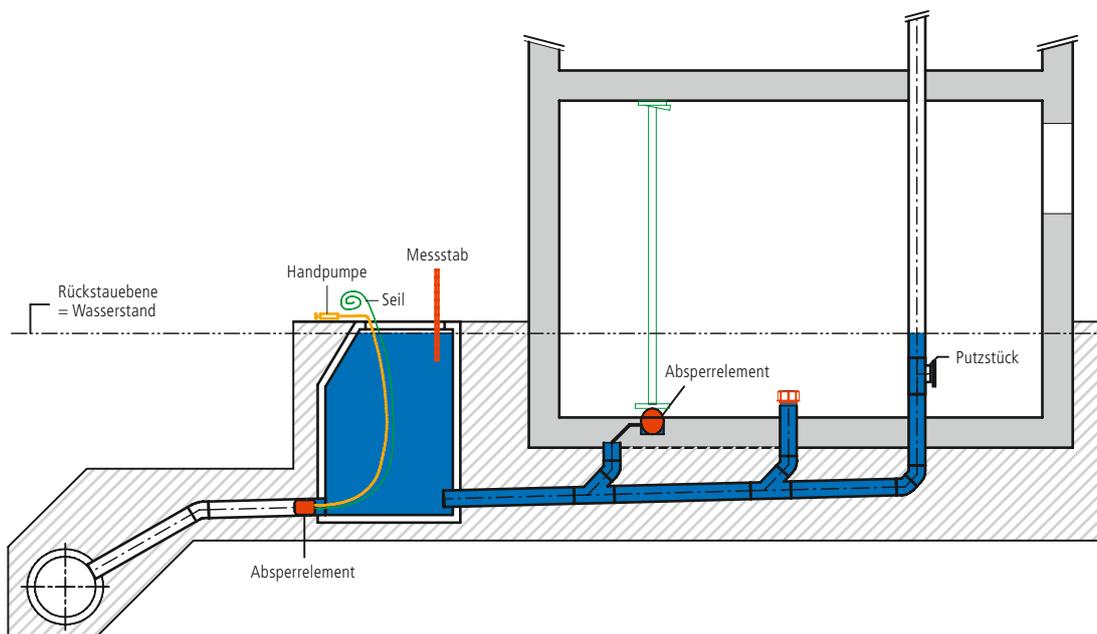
Füllprobe mit Wasser (mit Schacht)
